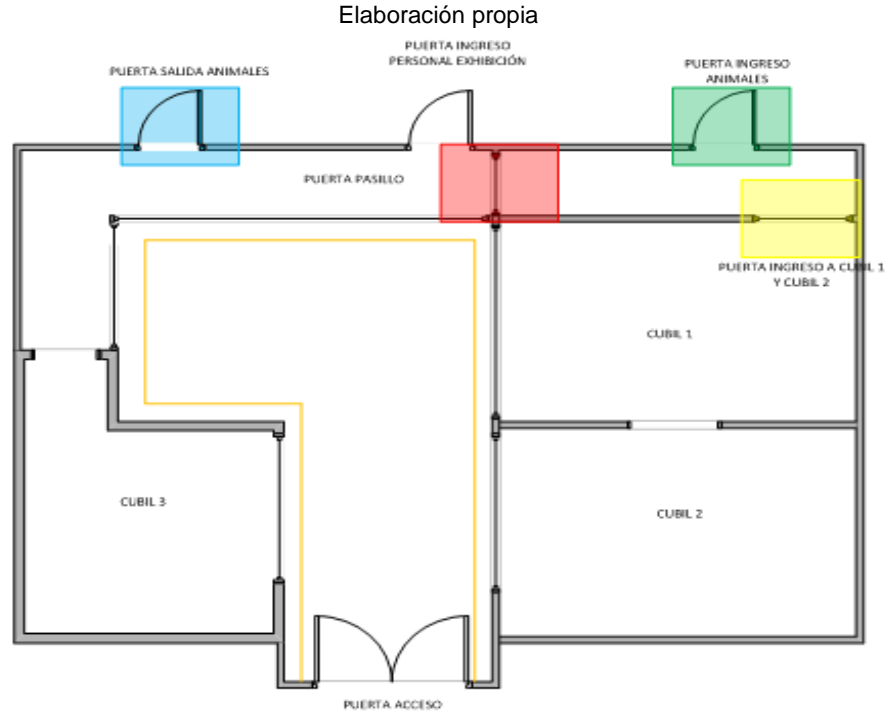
Plano del cubil de los Leones con los colores sugeridos para las guillotinas de las puertas
